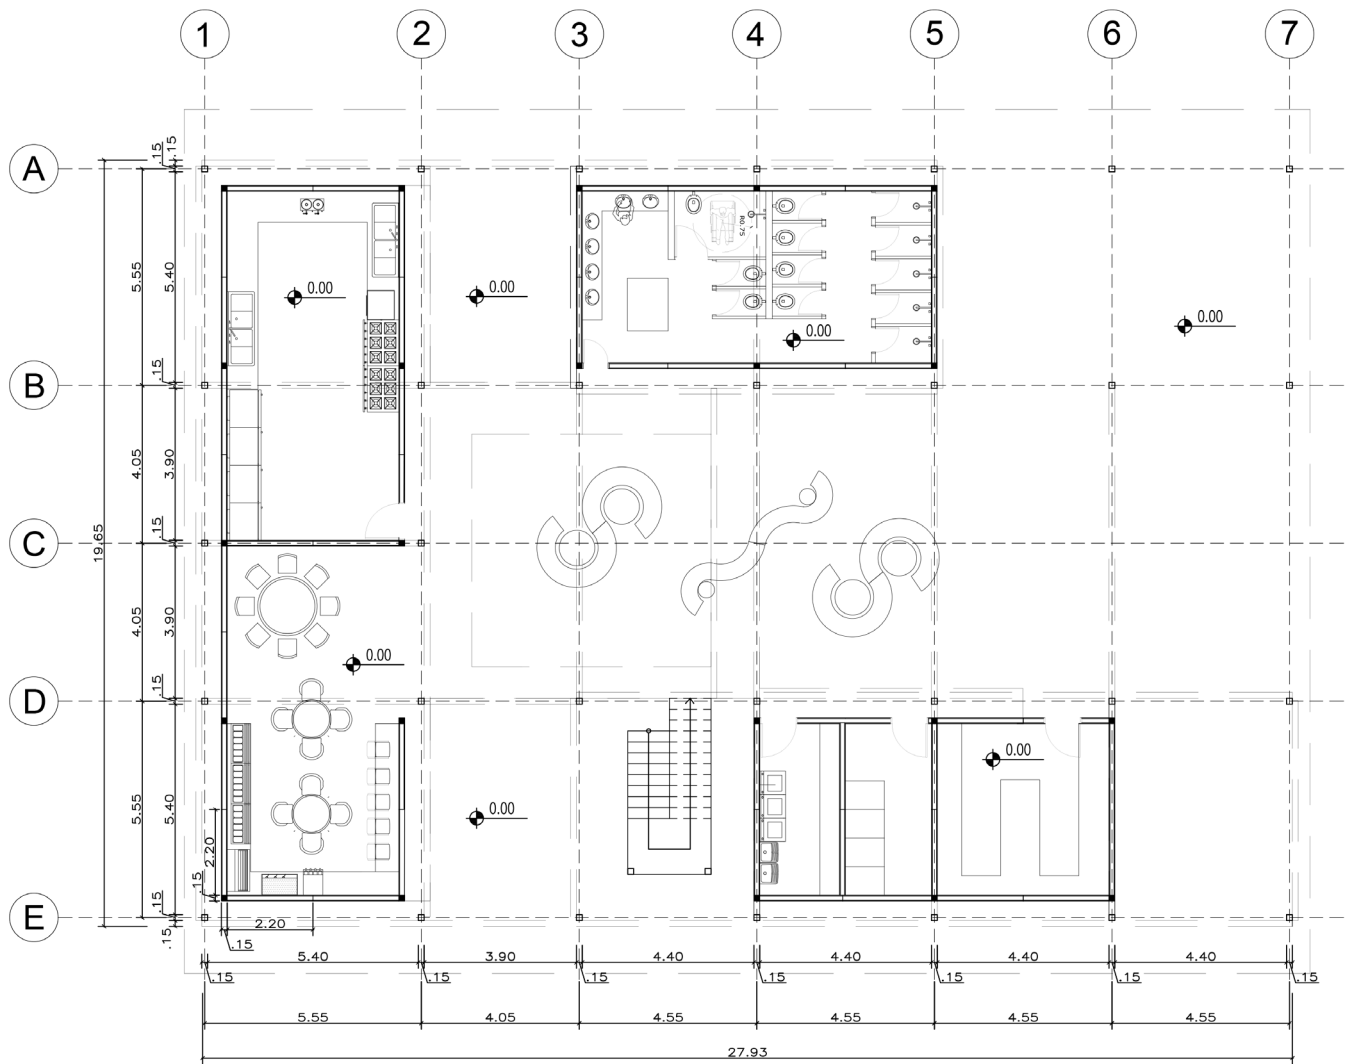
Planta térreo / Fonte: Autoria do grupo.
